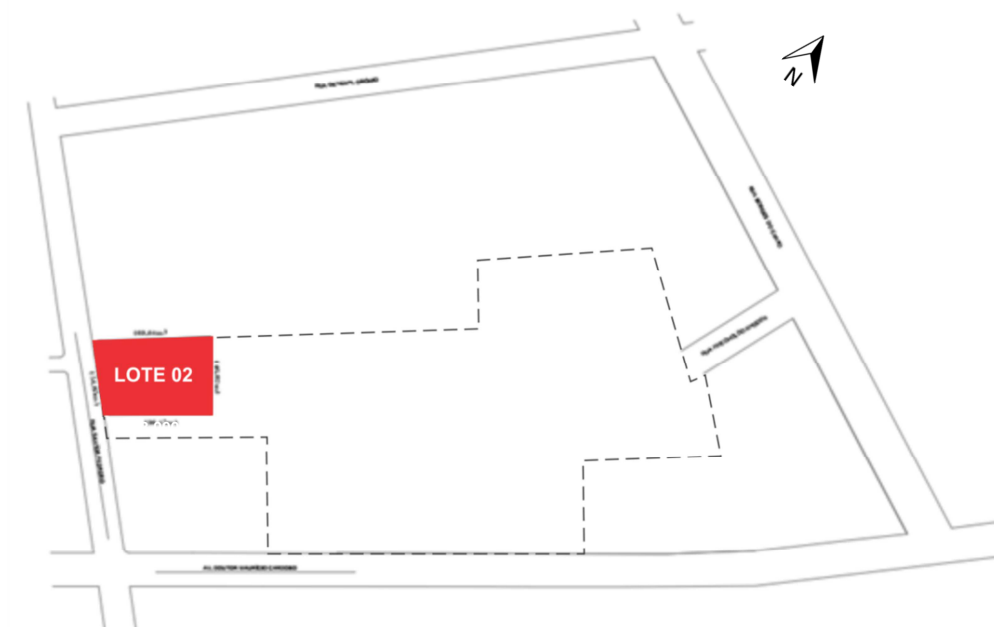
Planta de Situação do Lote 02 Desmembrado. Fonte Acervo do empreendedor.
